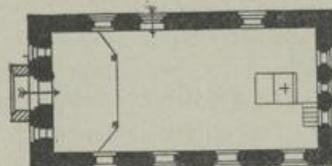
Drense. Grundriß der Kirche. (Nach einer älteren Zeichnung beim Staatlichen Hochbauamt in Prenzlau.)
